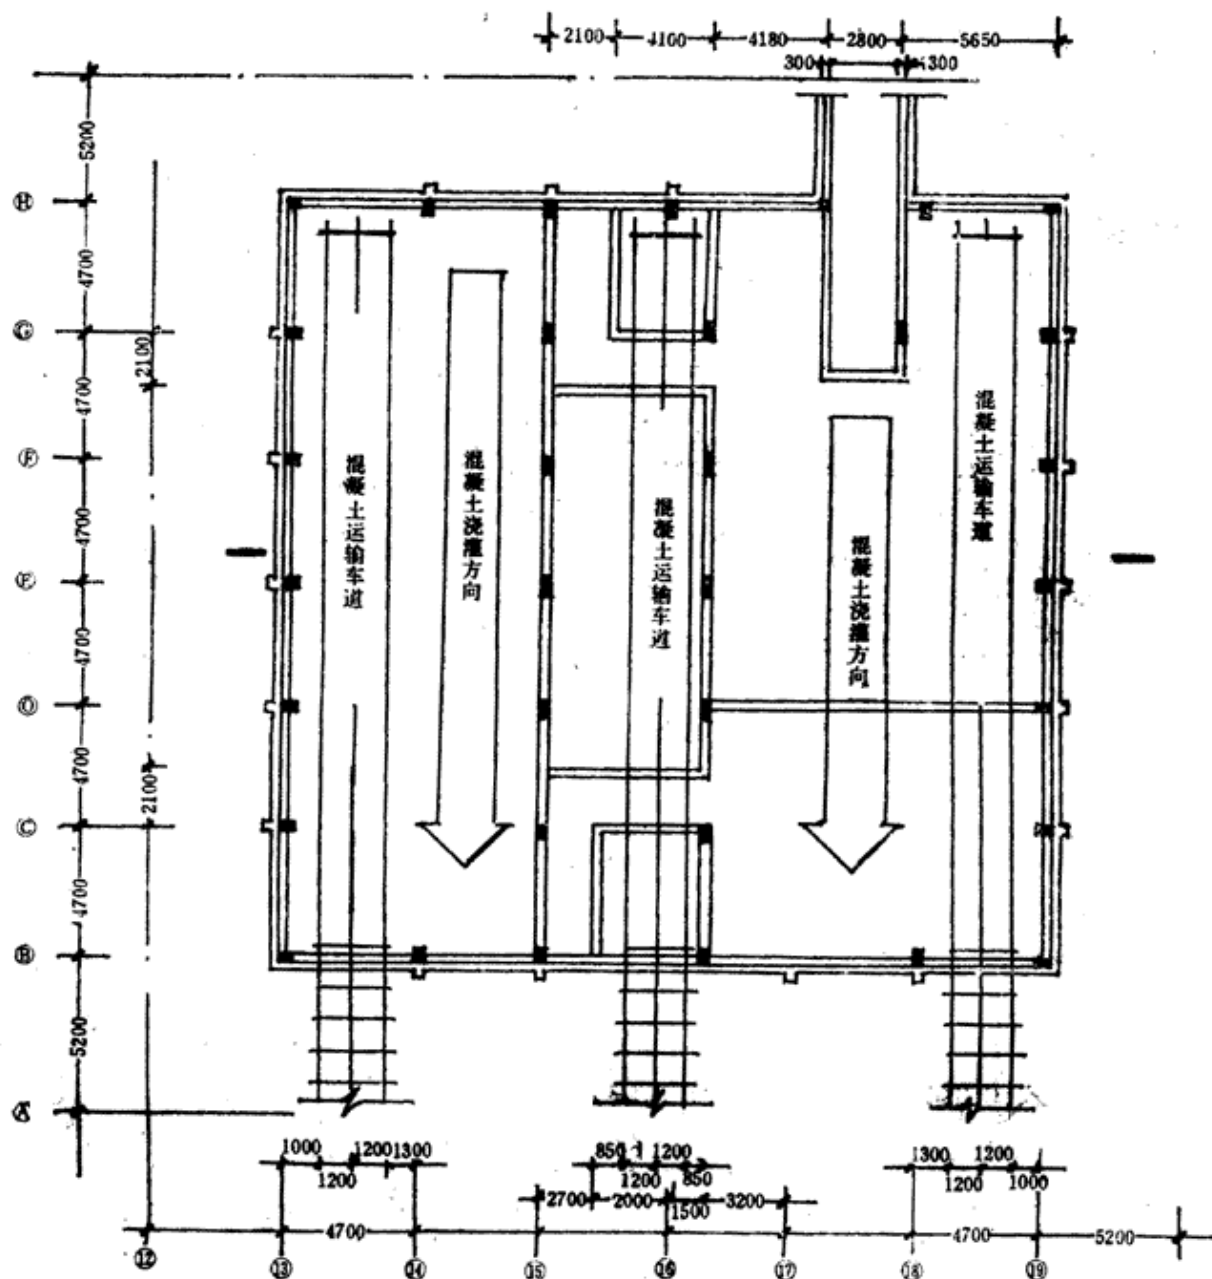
地下室混凝土浇灌顺序、车道平面图
